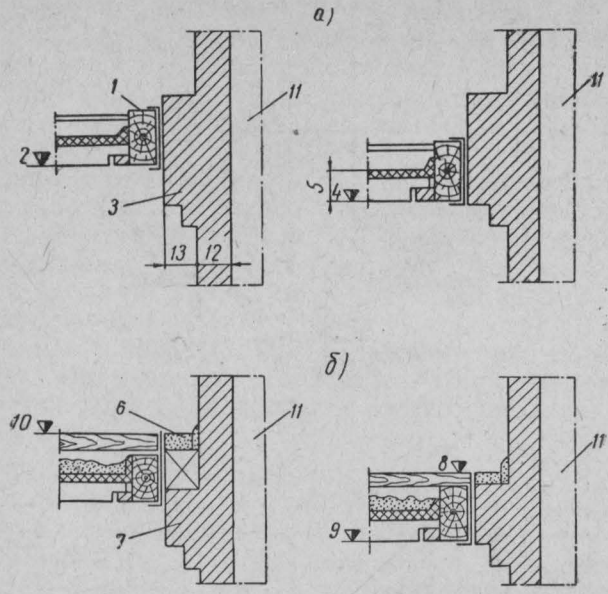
Устройство горизонтальных разделок с учетом осадки стен:
